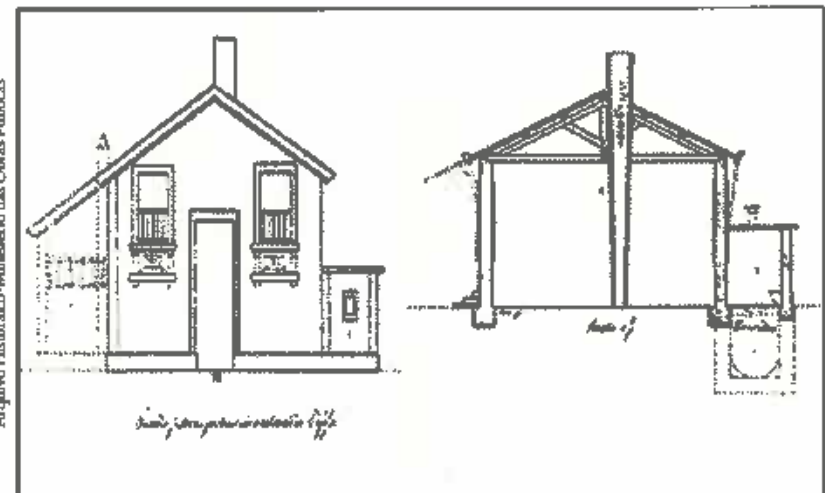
Fachada posterior e respectivo corte transversal, (Habitação do Professor).
